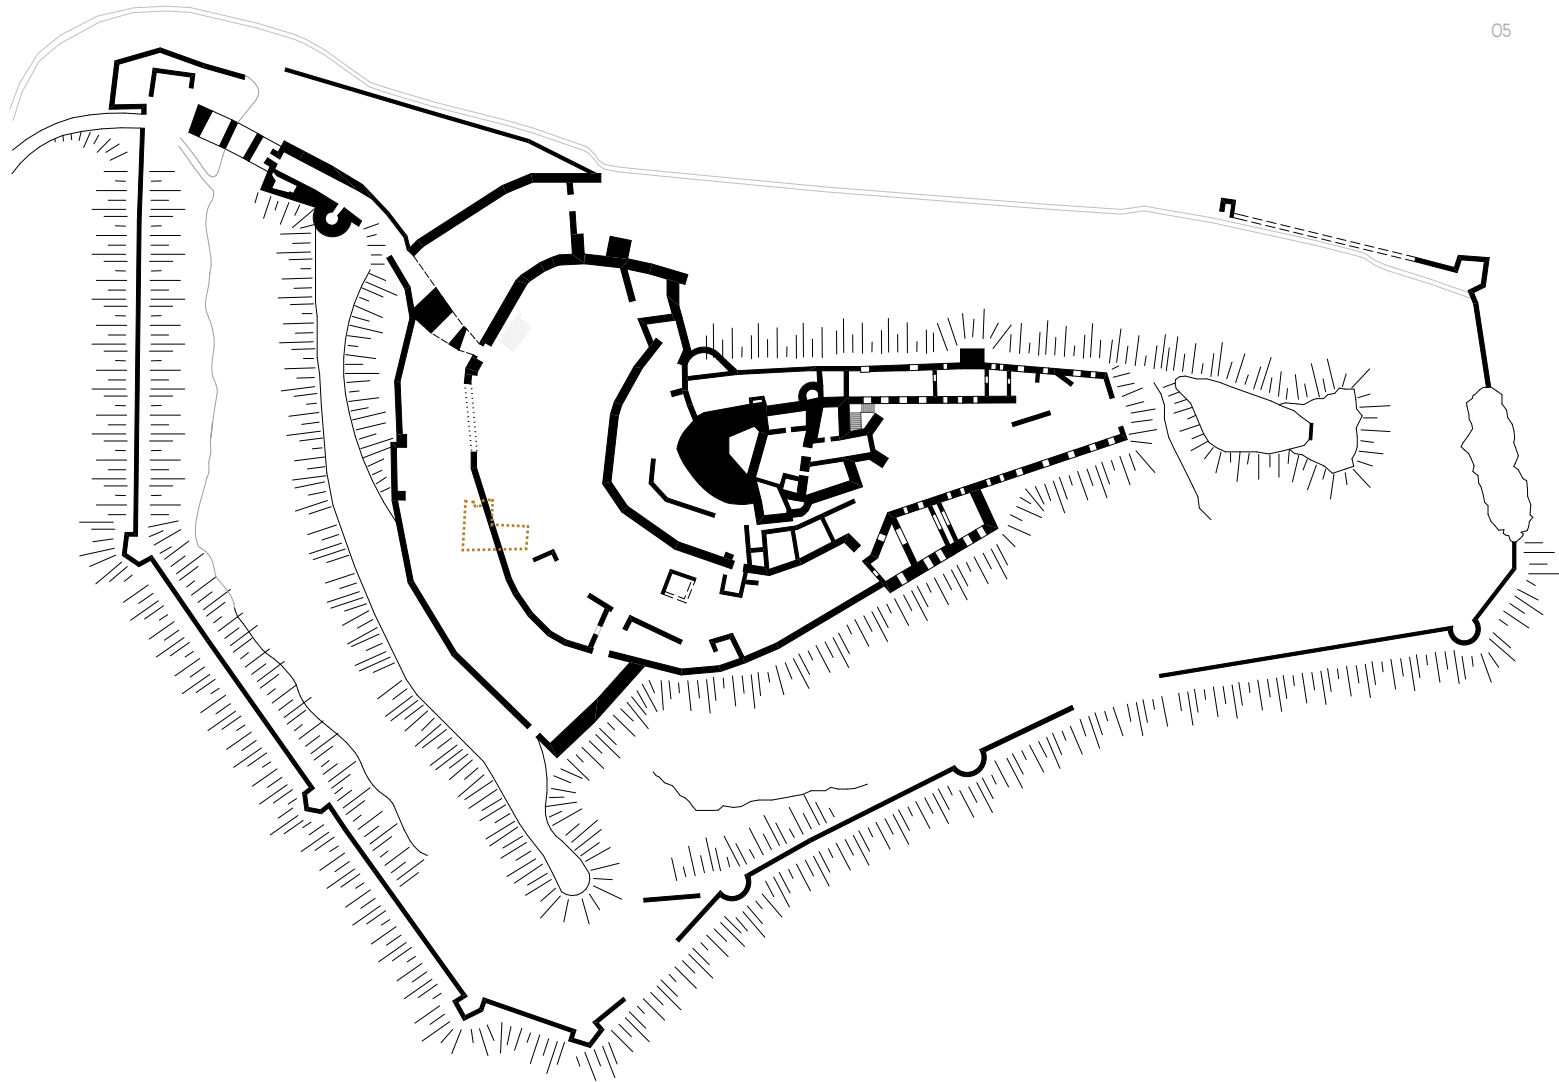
Grundriss Bestand I Ruine Landsee
